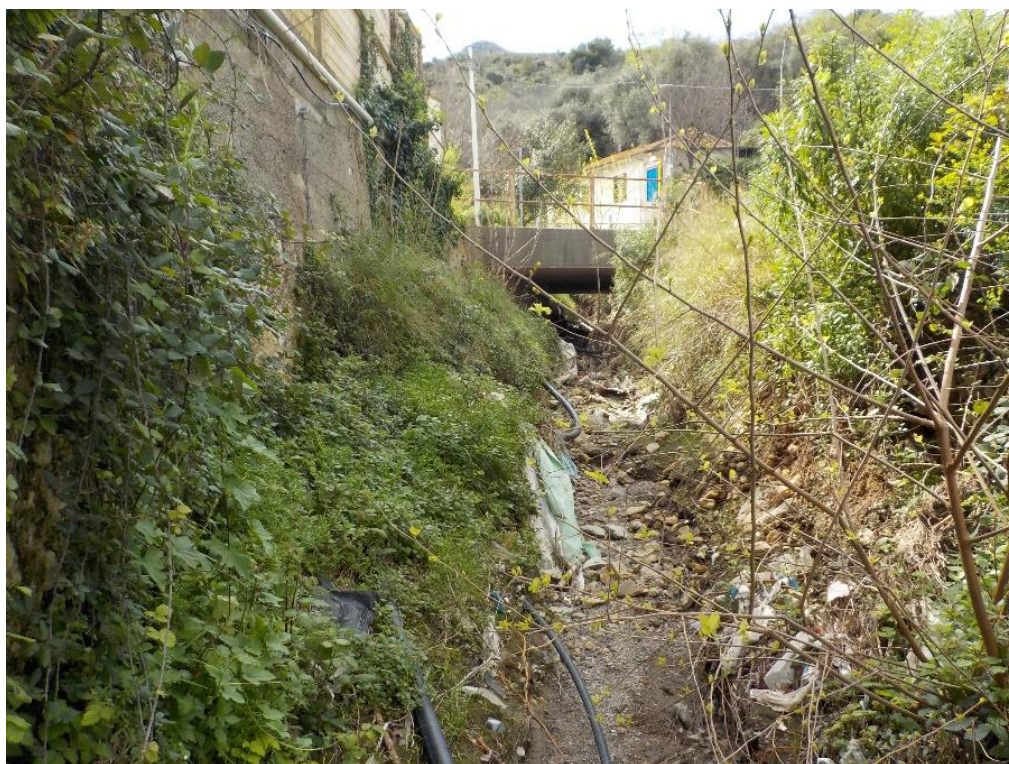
Vista da valle dell'attraversamento SP60 (CLV\_B2\_B3).
